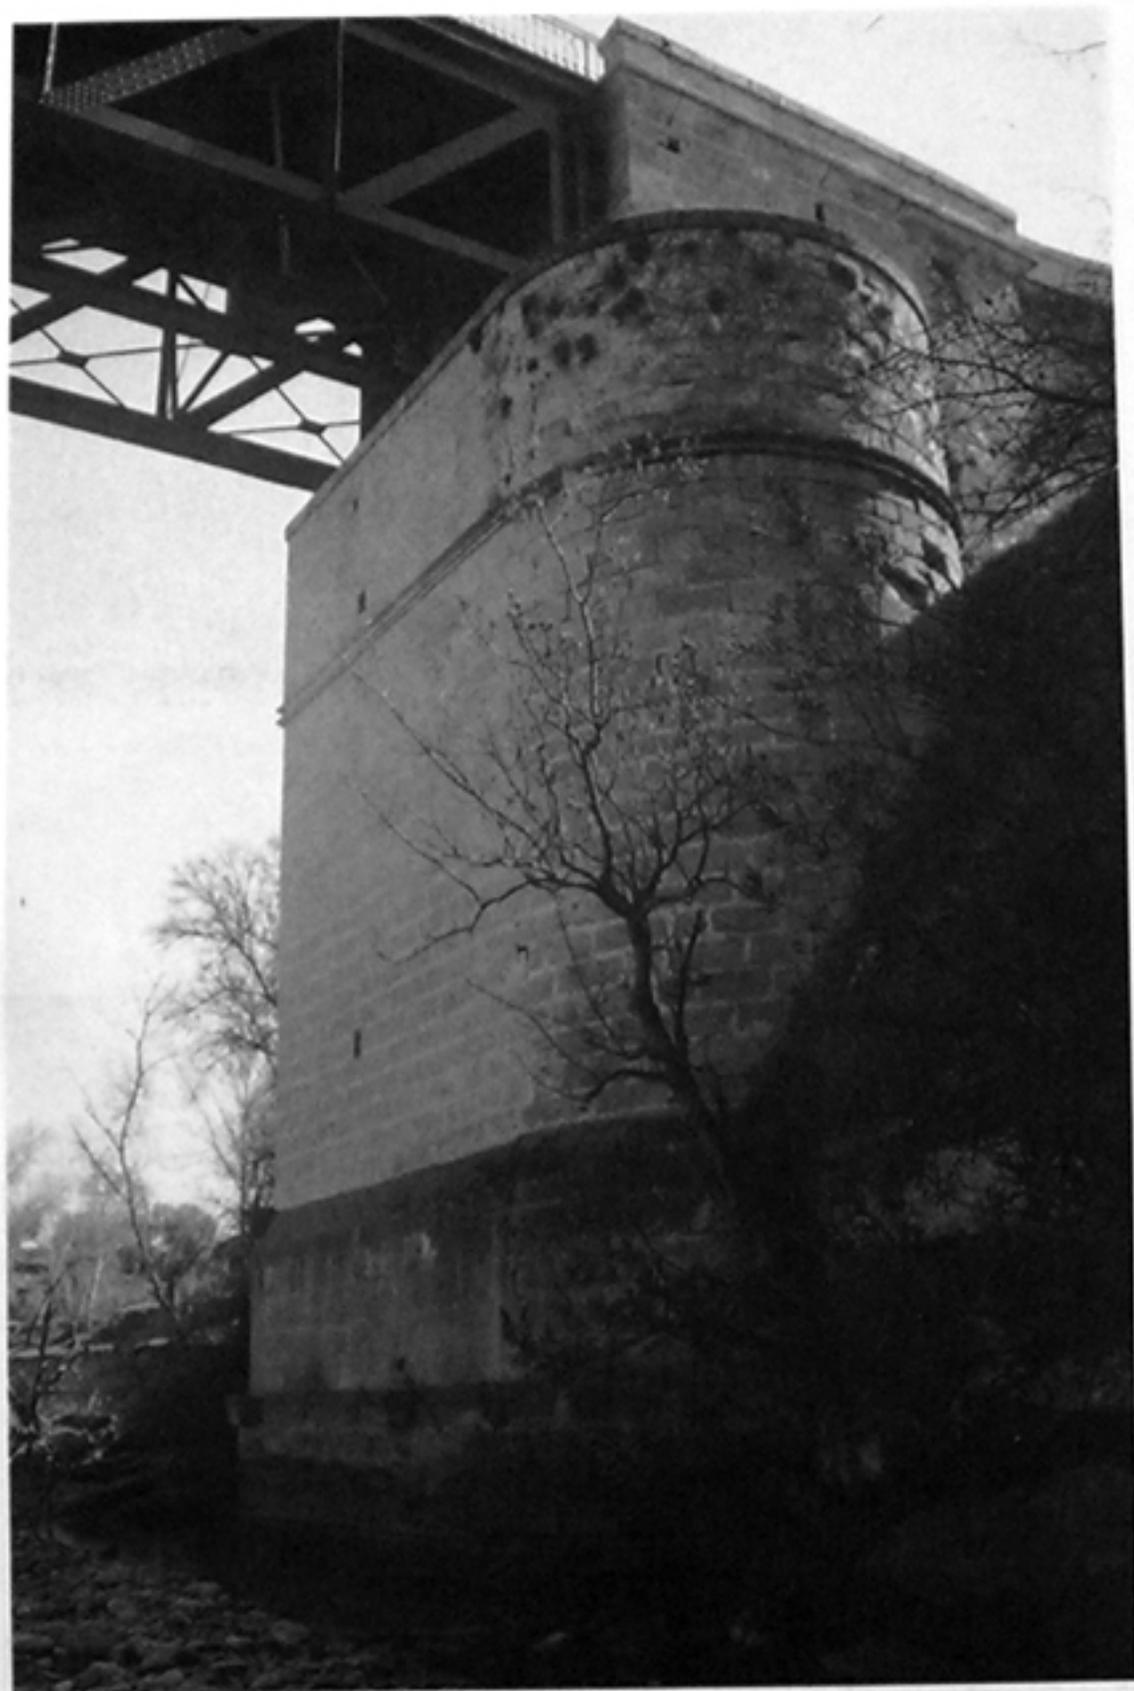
Puente de Mazuecos. Detalle del estribo meridional.
